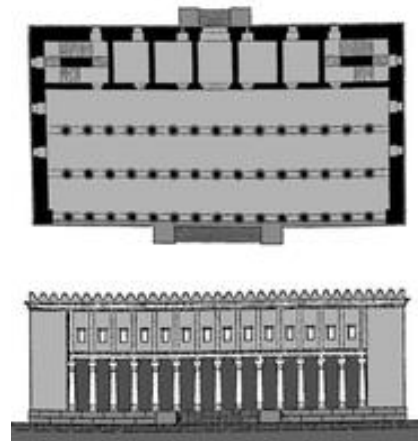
Rekonstruktion des Libanonwaldhauses (nach Stade).
